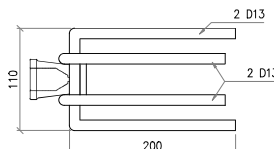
DETAIL SAMBUNGAN ANTAR SEGMENT GIRDER
